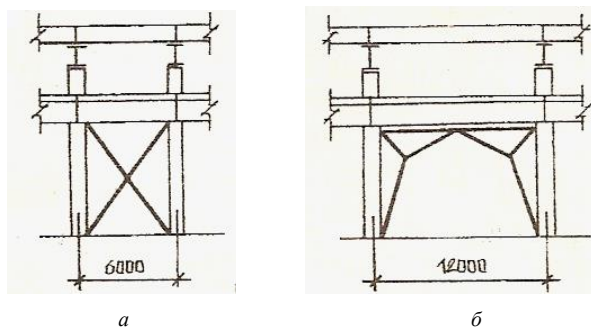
Вертикальные связи по железобетонным колоннам:
